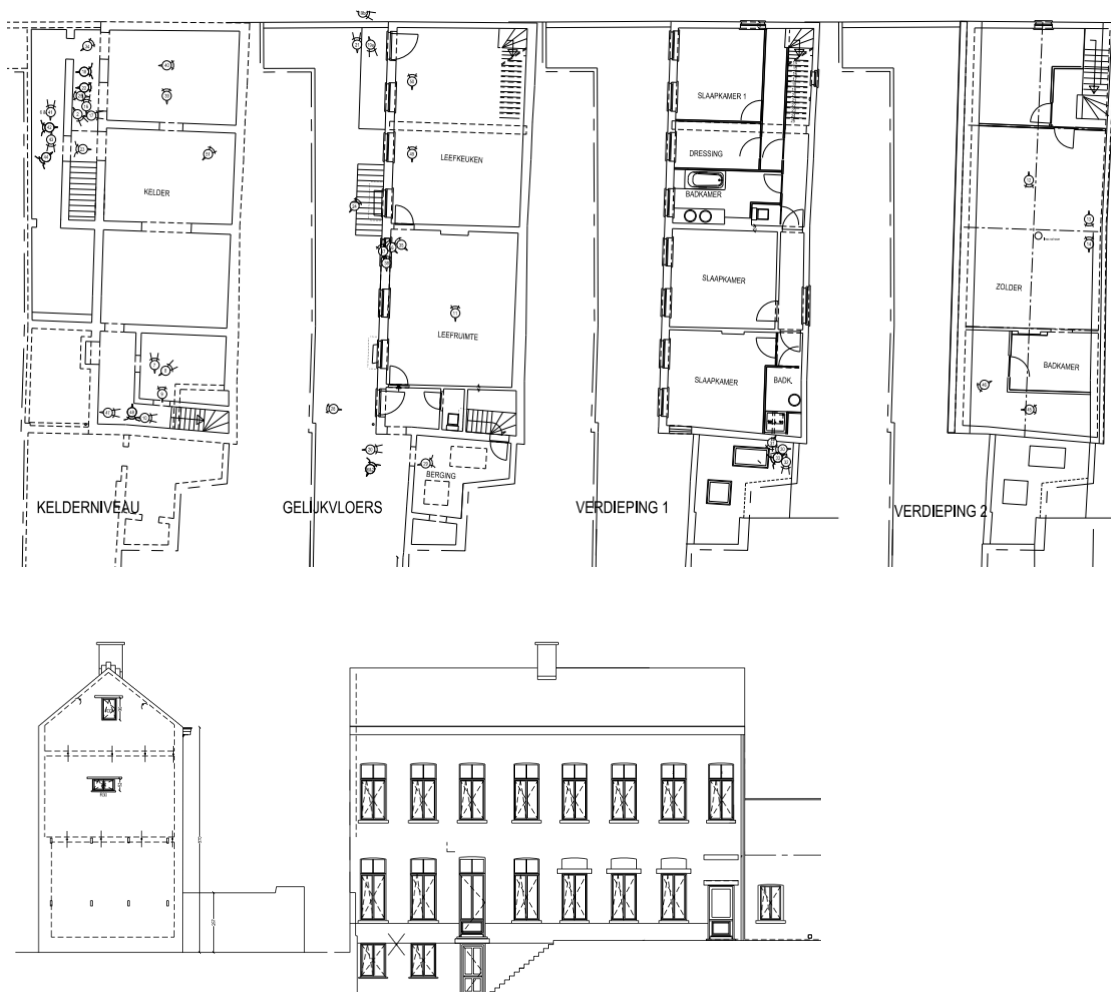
plan bestaande toestand verbouwing 2005, (bron : digitaal archief arch. J.Van Dorpe)
